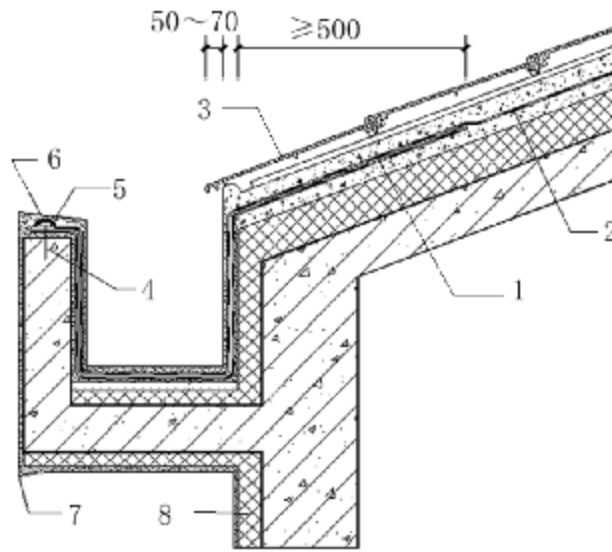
烧结瓦、混凝土瓦屋面檐沟
